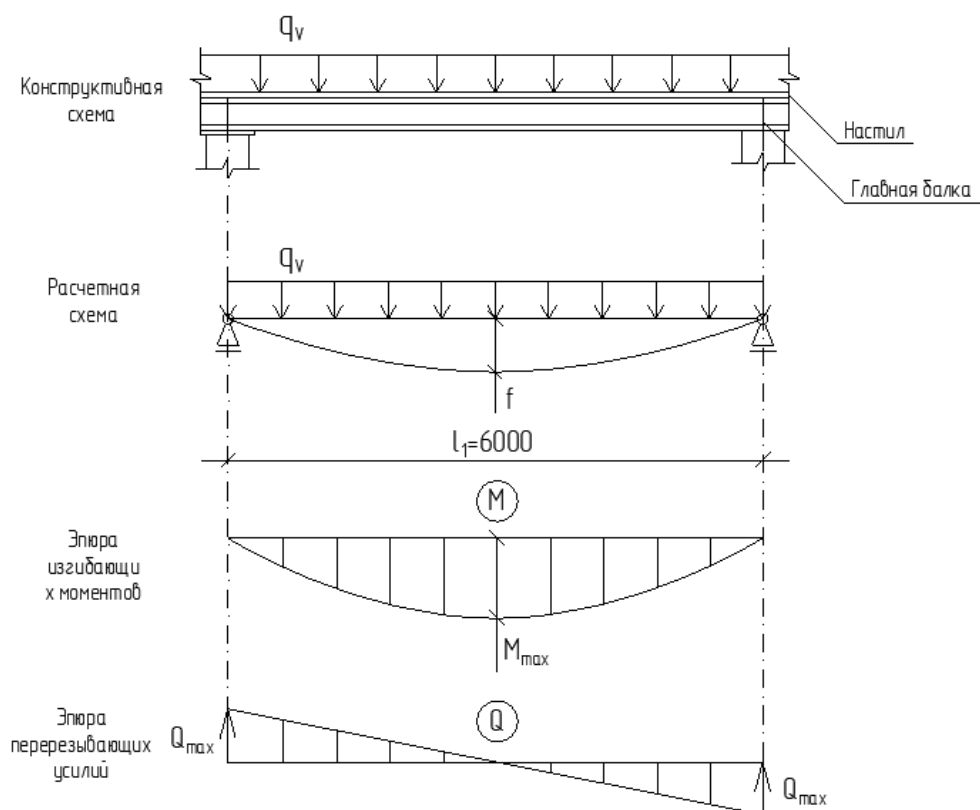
Расчетная и конструктивная схемы главной балки
